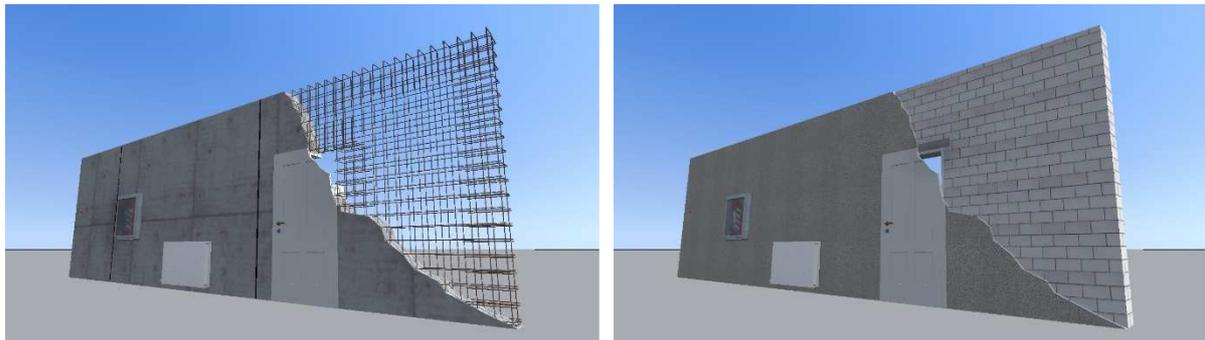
Modelle der Prüfscenarien: Stahlbeton- (links) und Mauerwerkswand (rechts)¹²⁰
